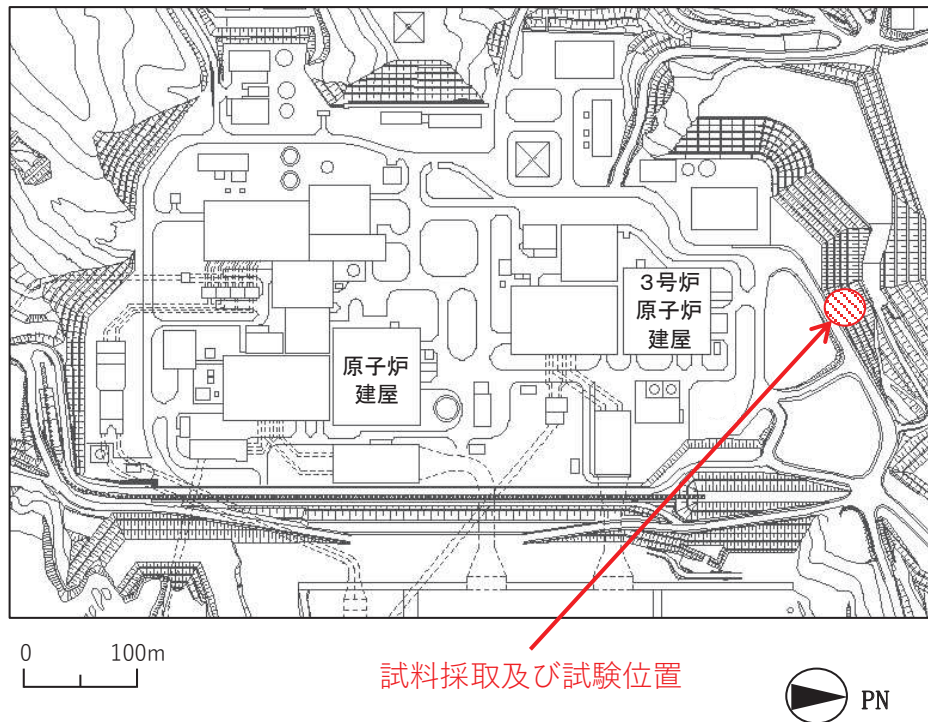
(3) 試料採取位置 (第3号機原子炉建屋北側, 牧の浜部層)
